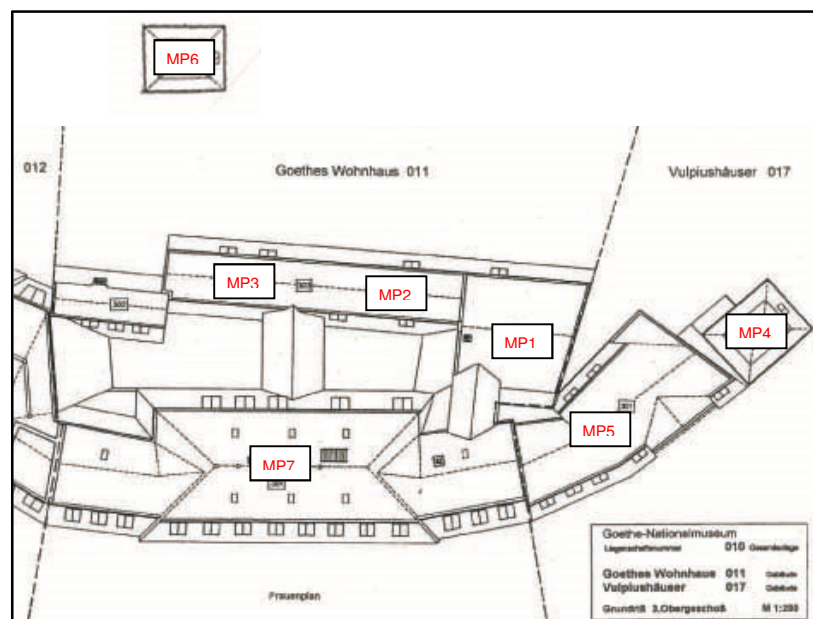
Grundriss des Prüfobjektes mit Probenahmepunkten im Dachbereich
